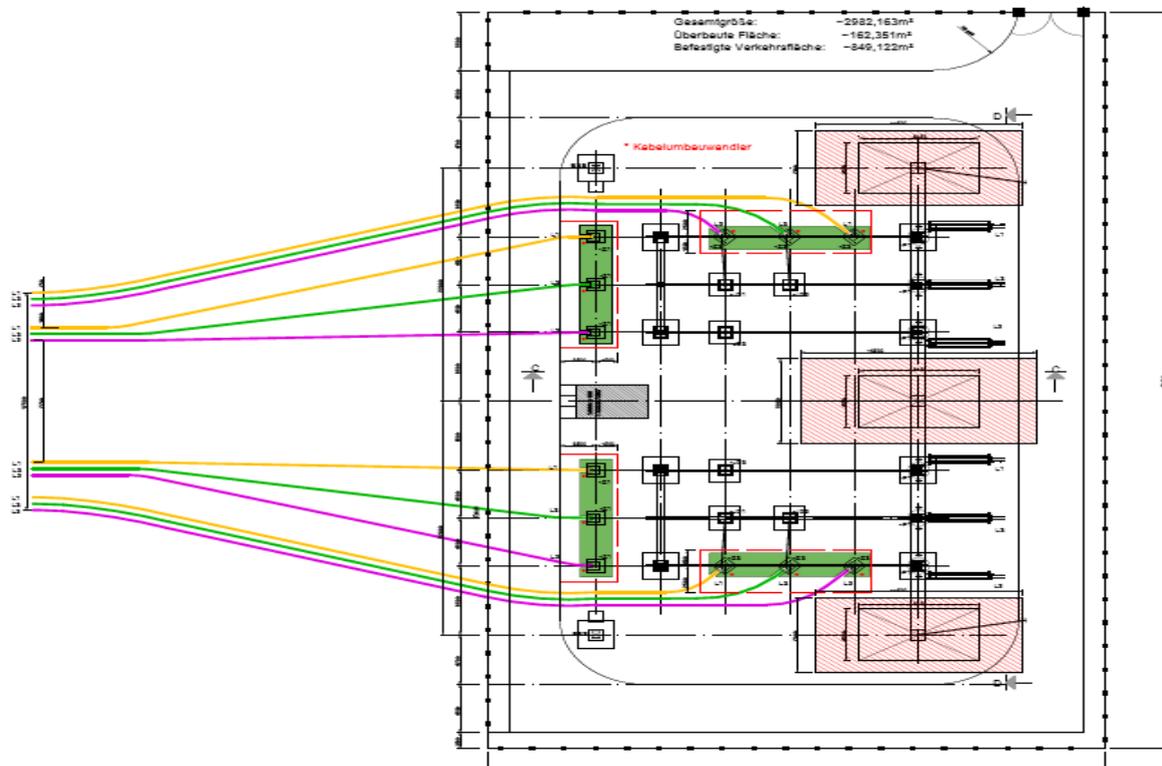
Kabelübergangsanlage, exemplarische Darstellung (Grundriss)
